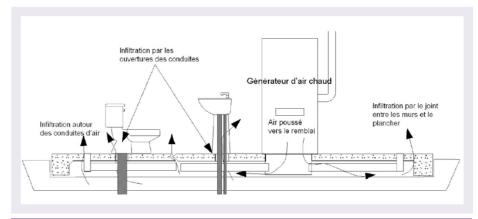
Voies d'entrée du radon liées aux fondations à dalle sur terre-plein
